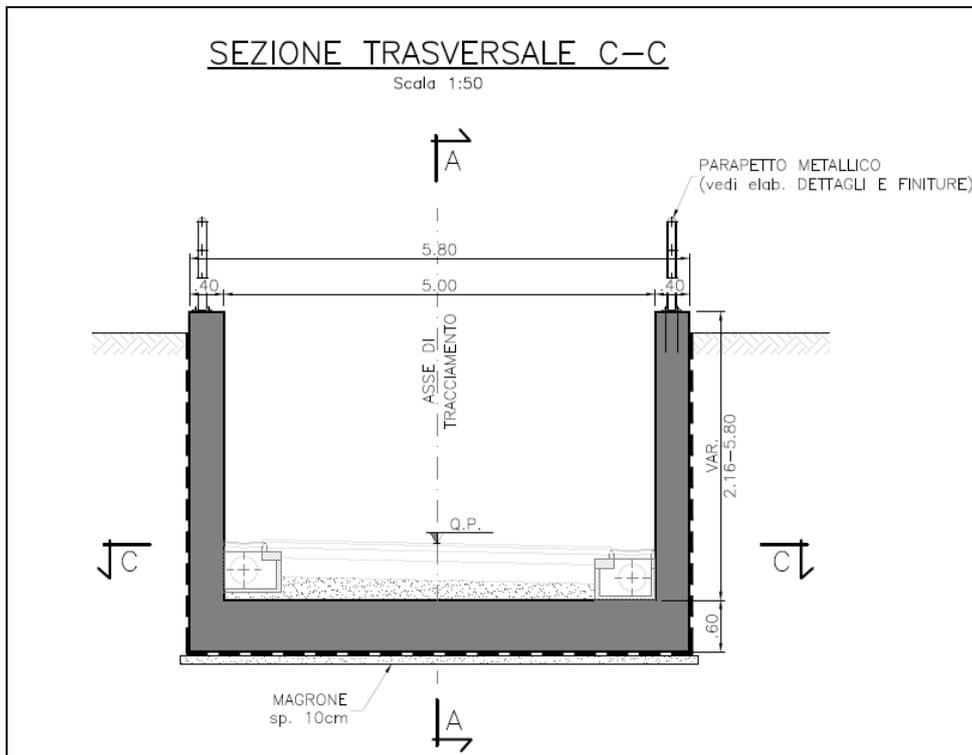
Sezione tipologica Muro ad U (Sezione C-C).
